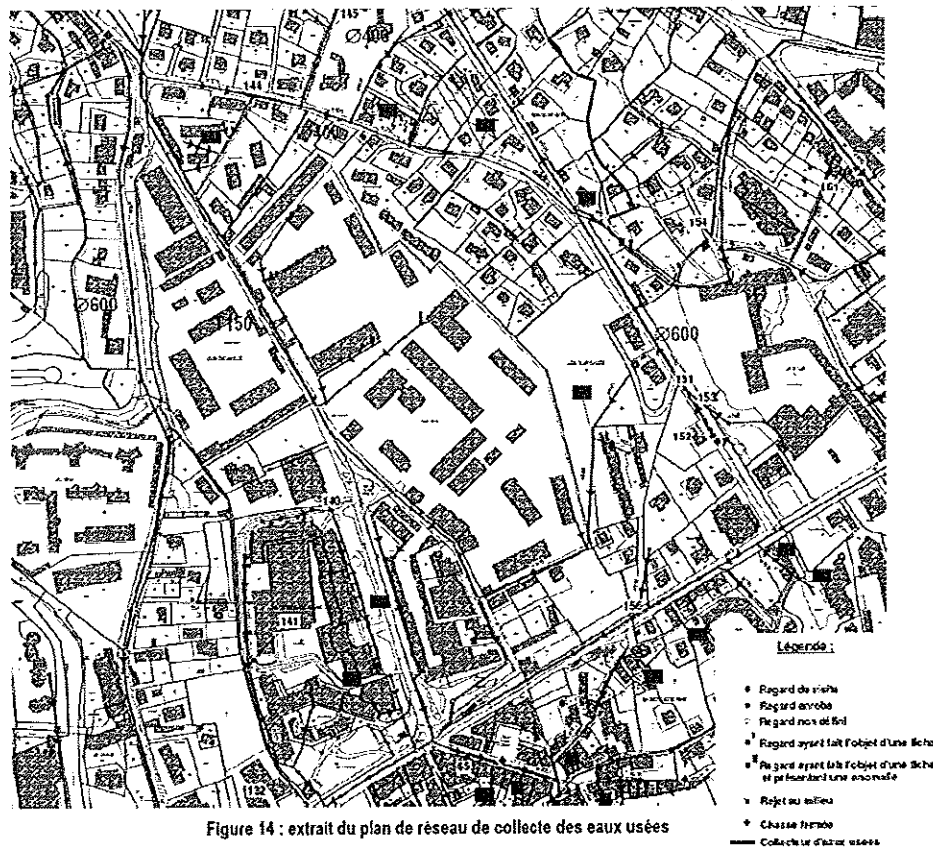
extrait du plan de réseau de collecte des eaux usées
